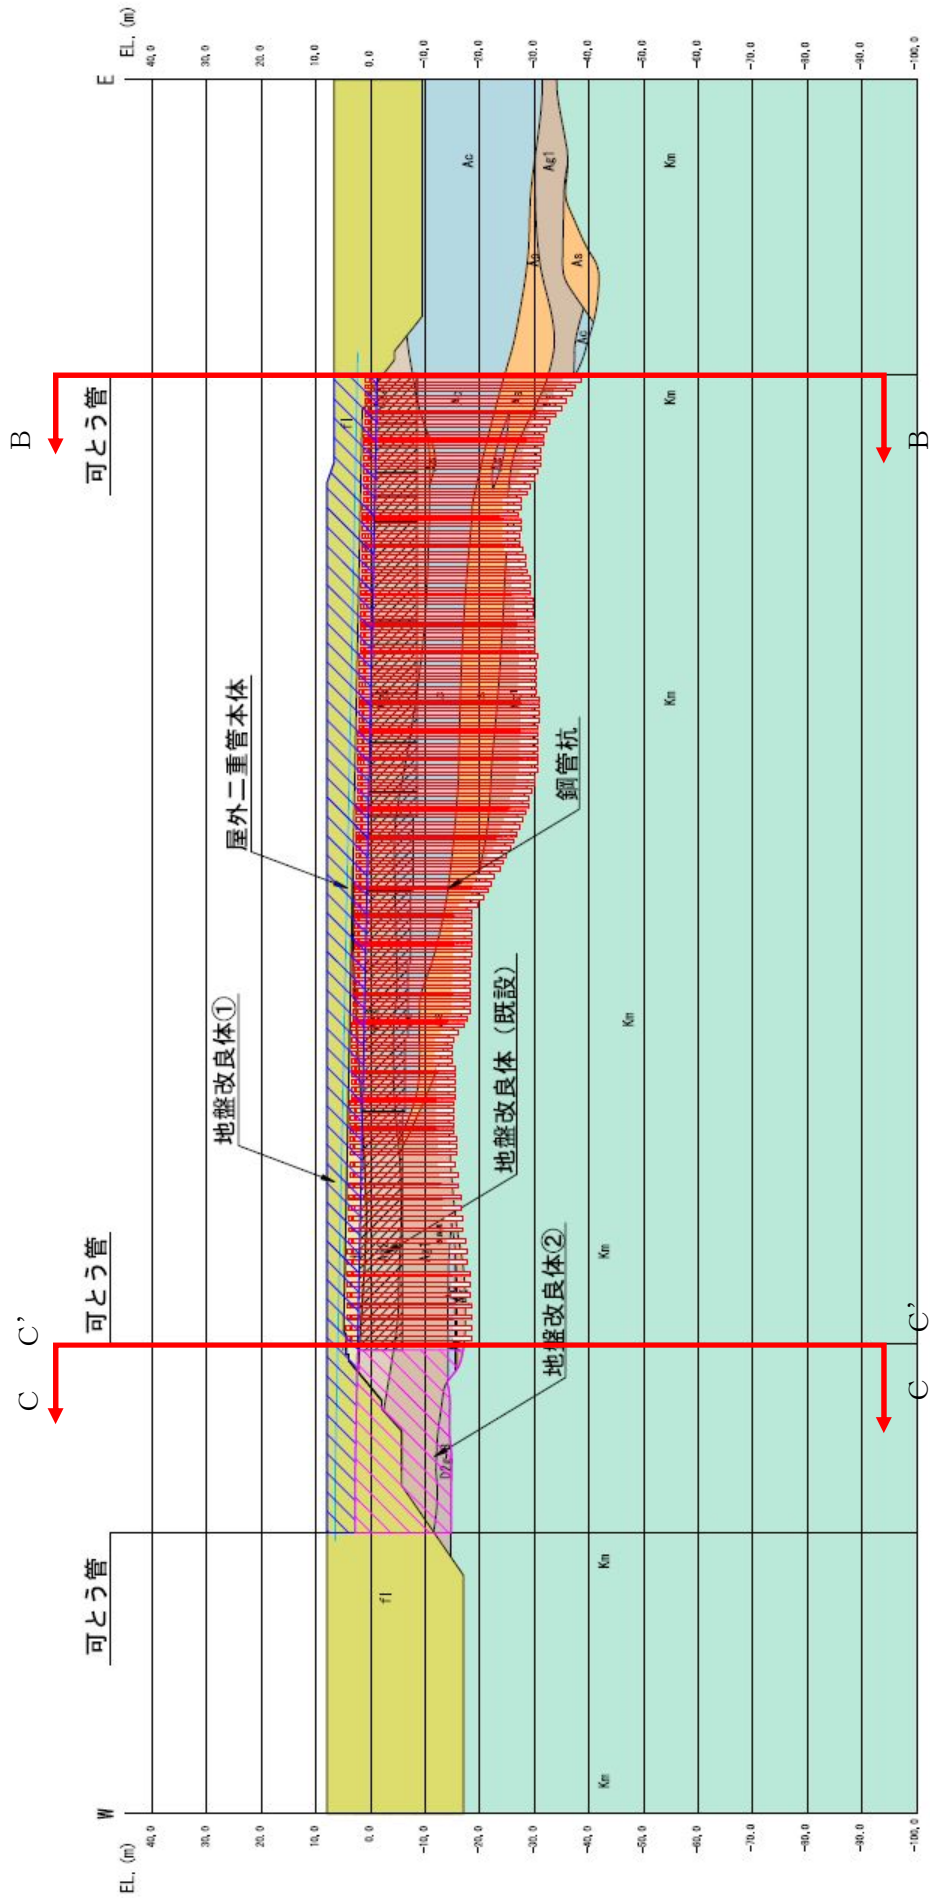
(1) 屋外二重管基礎の評価対象断面図 (A-A断面)
